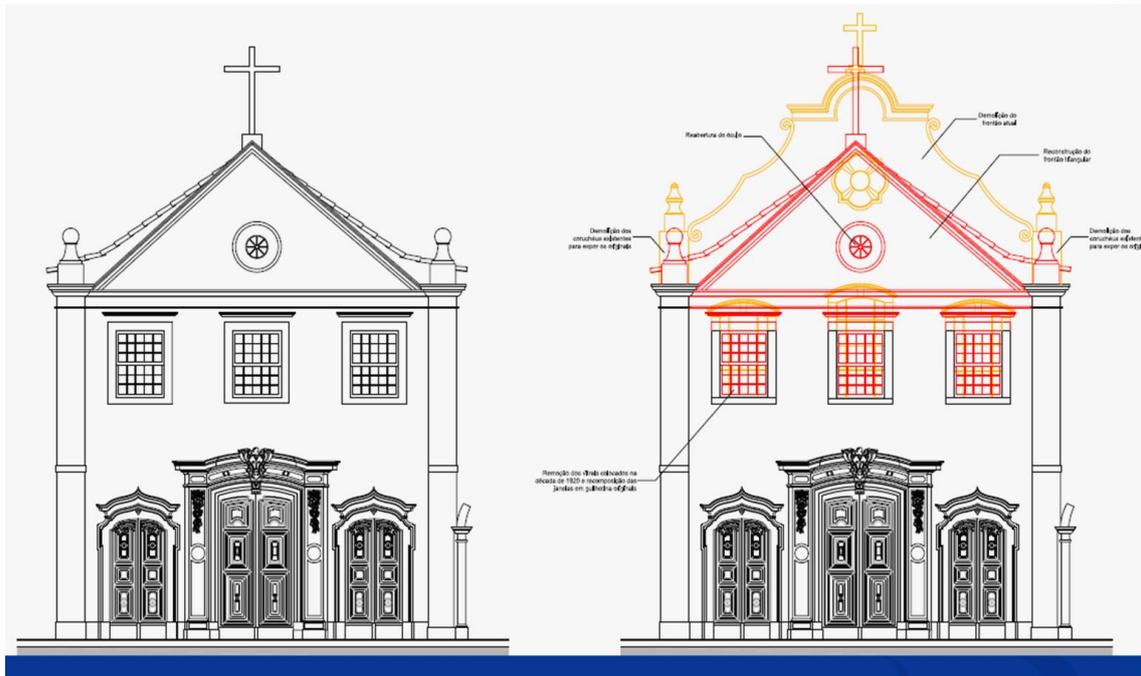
Fachada principal proposta e sua proposição sobre a atual.
